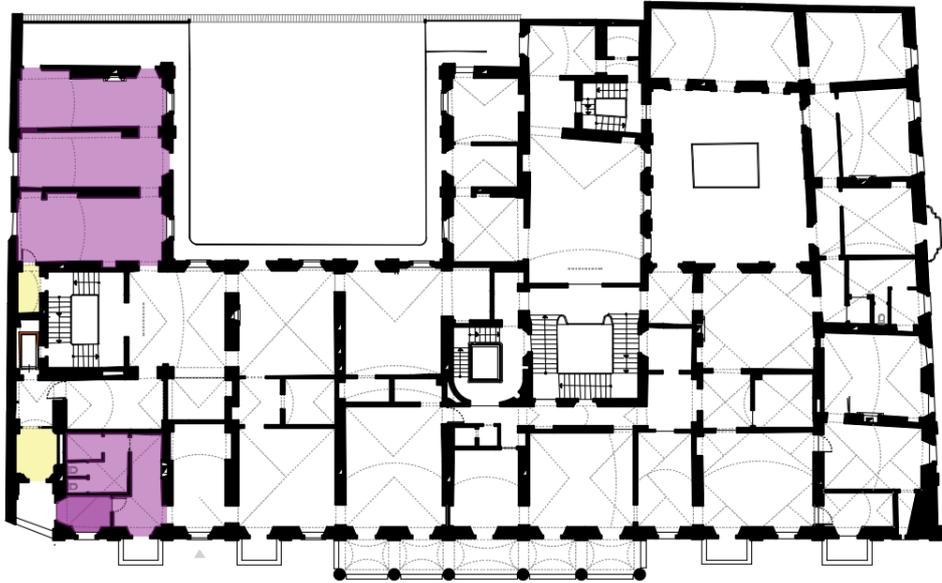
Estratto della pianta del piano terra che riporta il sistema di estrazione.
